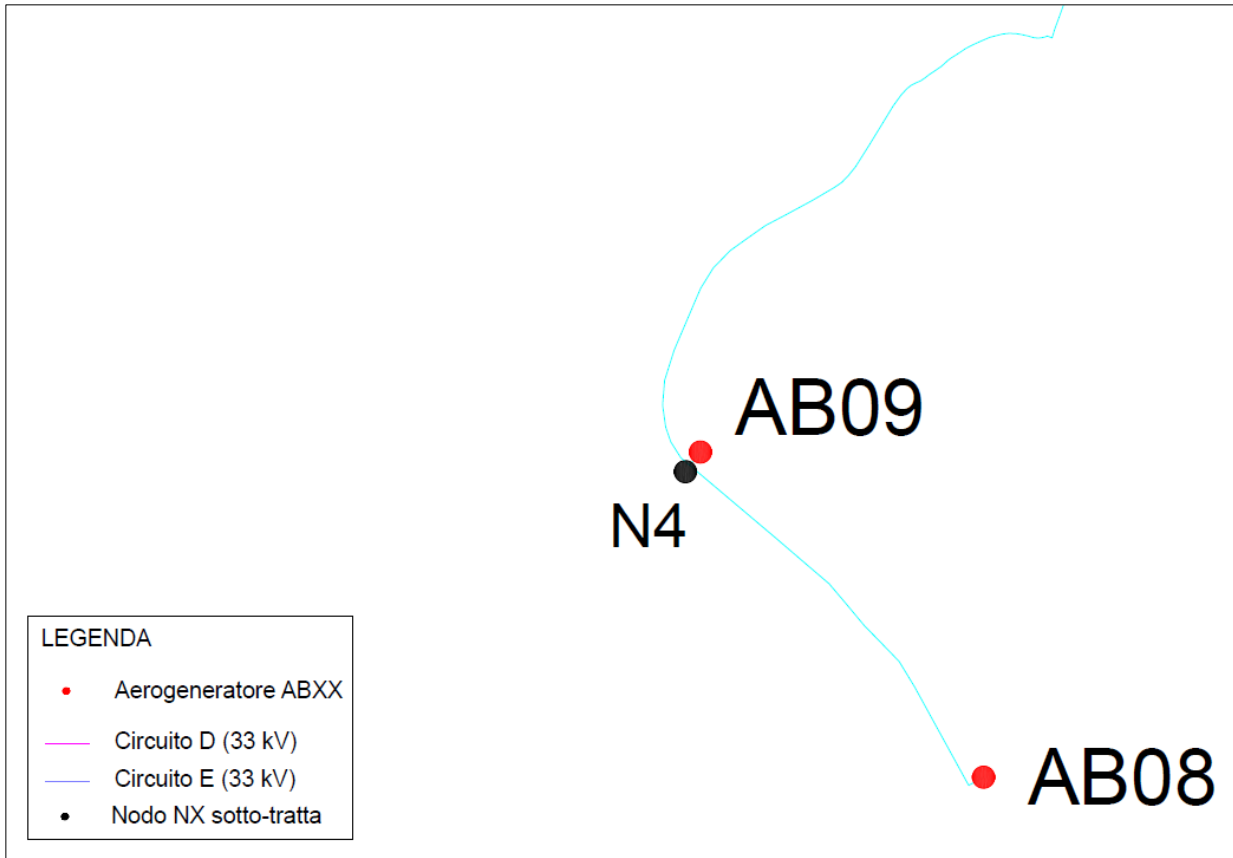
Dettaglio 4 di 4 della planimetria generale di distribuzione linee elettriche
